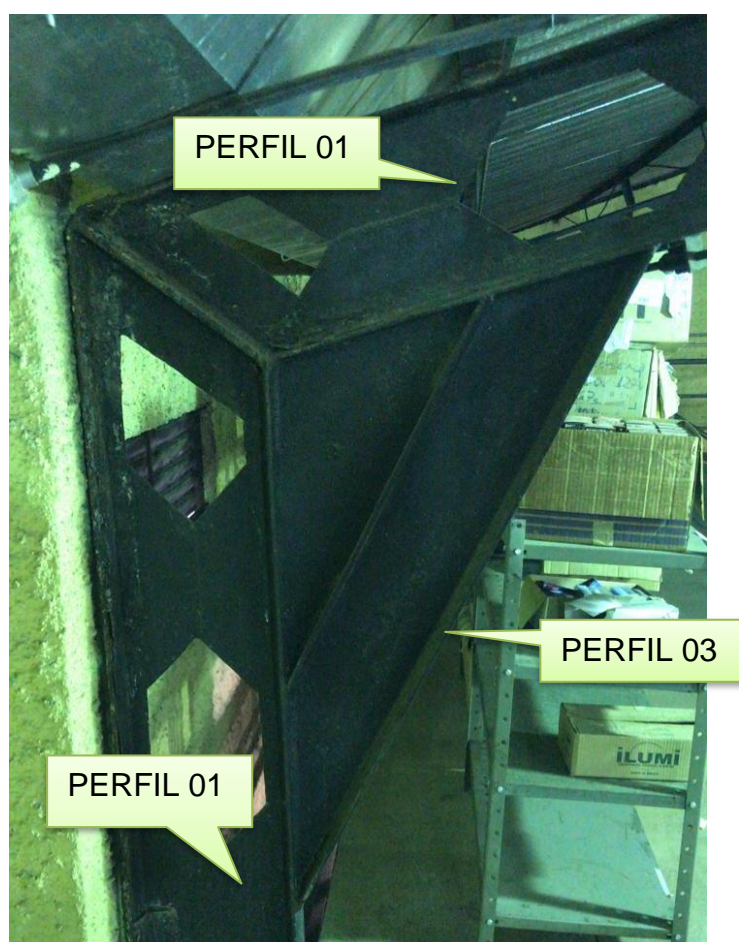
LIGAÇÃO ENTRE PILAR DA EXTREMIDADE E TESOURA
